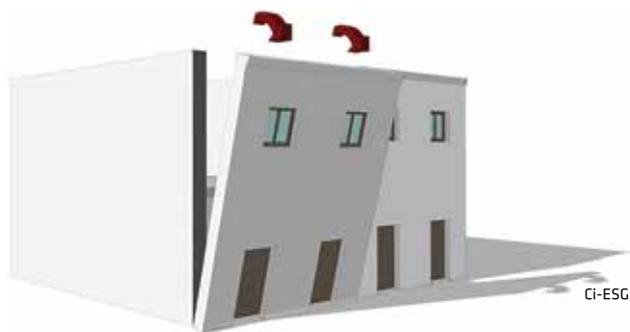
Falha de coesão entre paredes perpendiculares Improper connection between perpendicular walls
